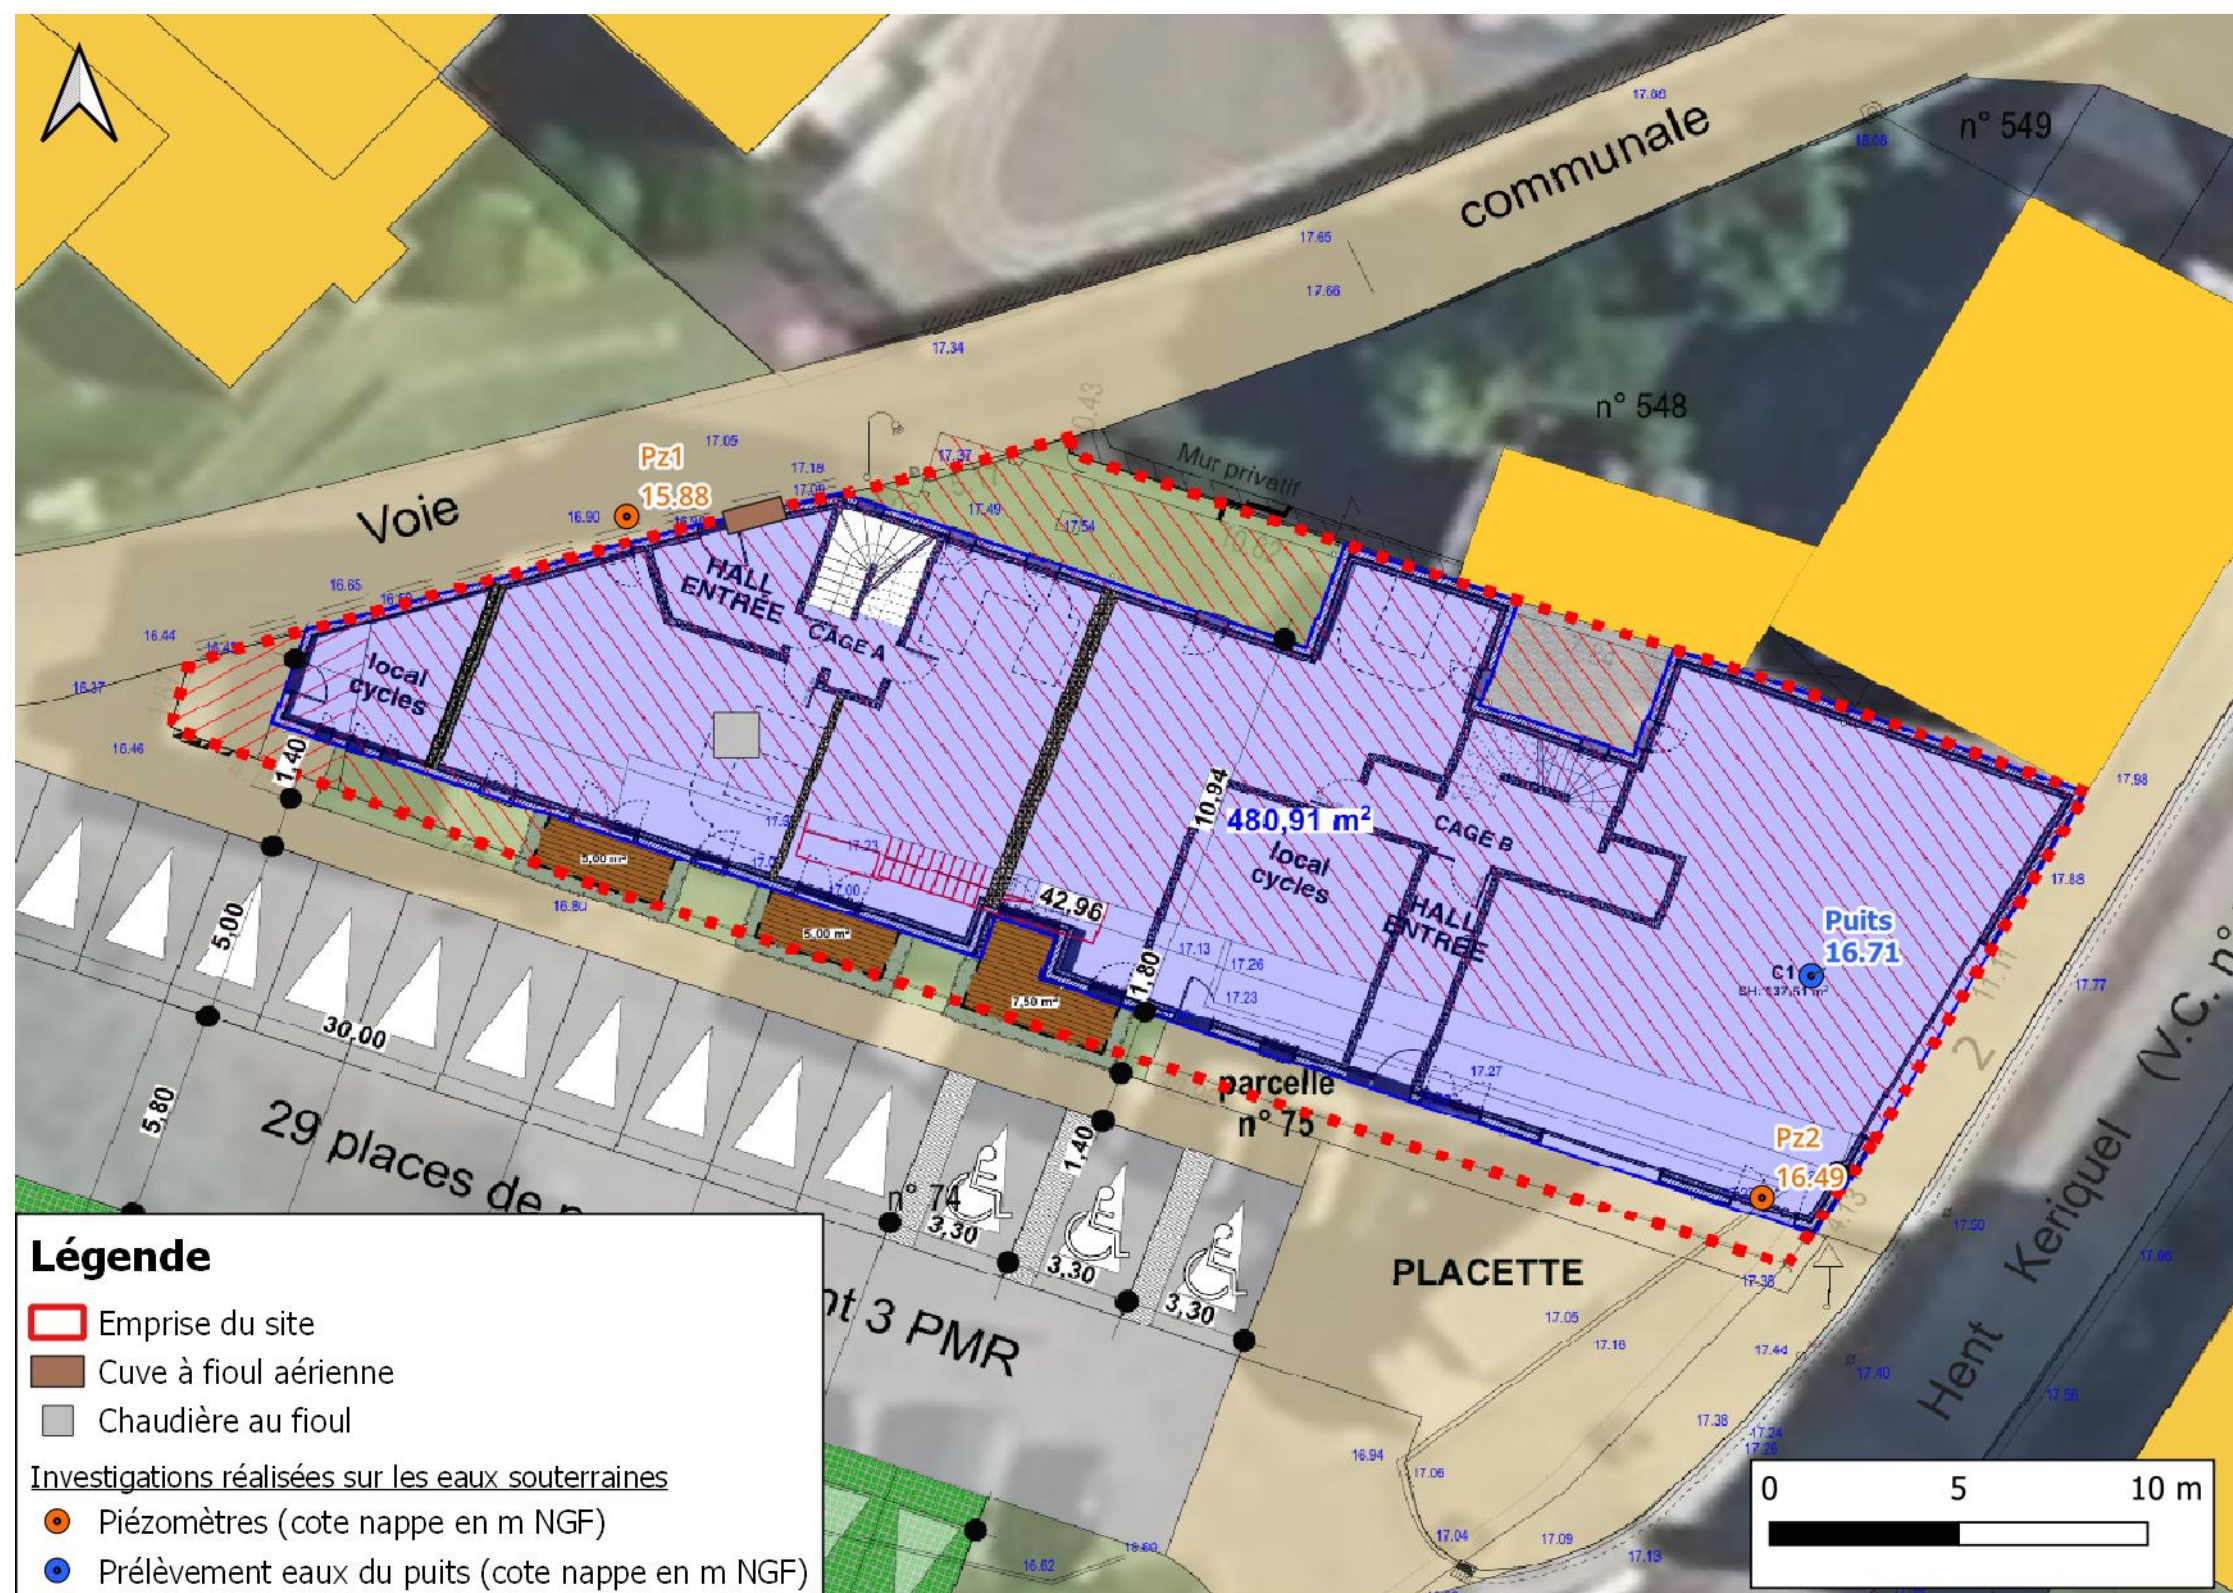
Localisation des prélèvements d'eaux souterraines sur fond du plan de projet
